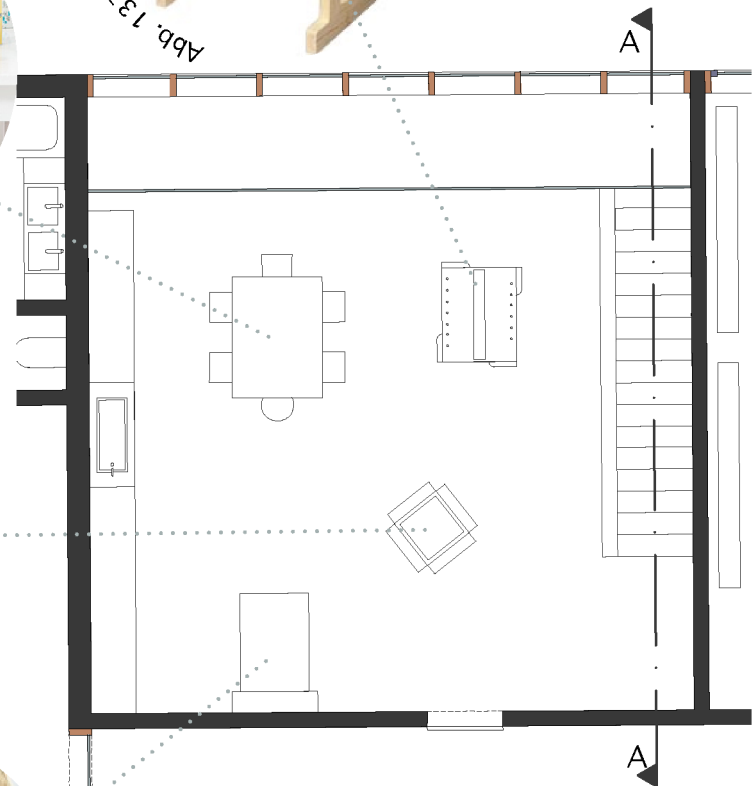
Grundriss Obergeschoss Kreativraum 1:100
